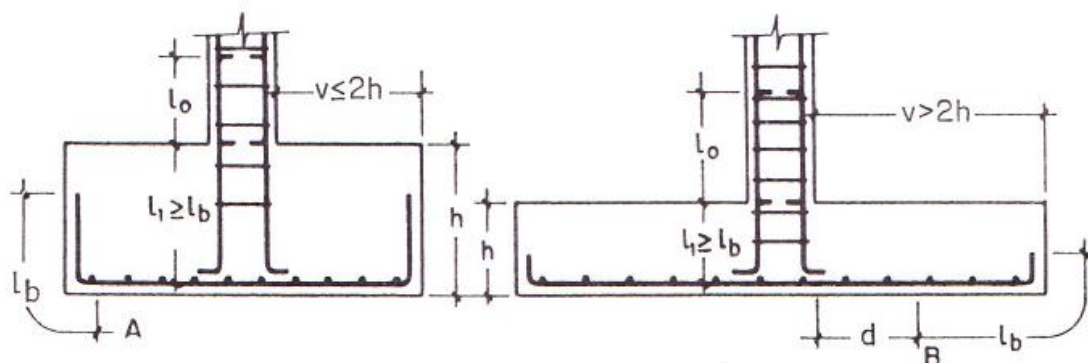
Anclaje de barras de zapatas rígidas a) y flexibles b) (fuente: Jiménez Montoya)
